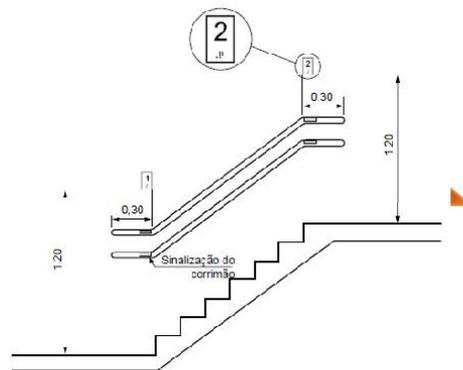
Sinalização de pavimento - Vista lateral (cotas em metros)
